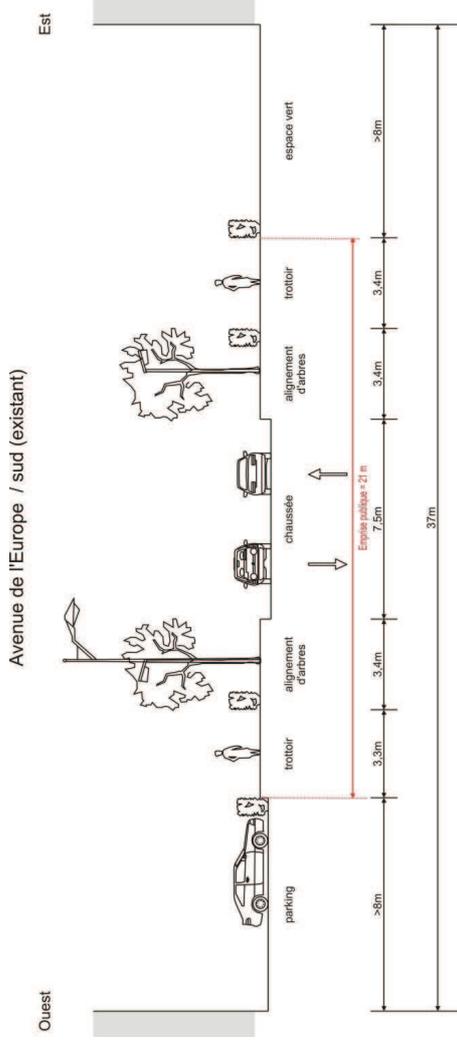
Situation existante (coupe 28) avenue de l'Europe / section "Sud"
